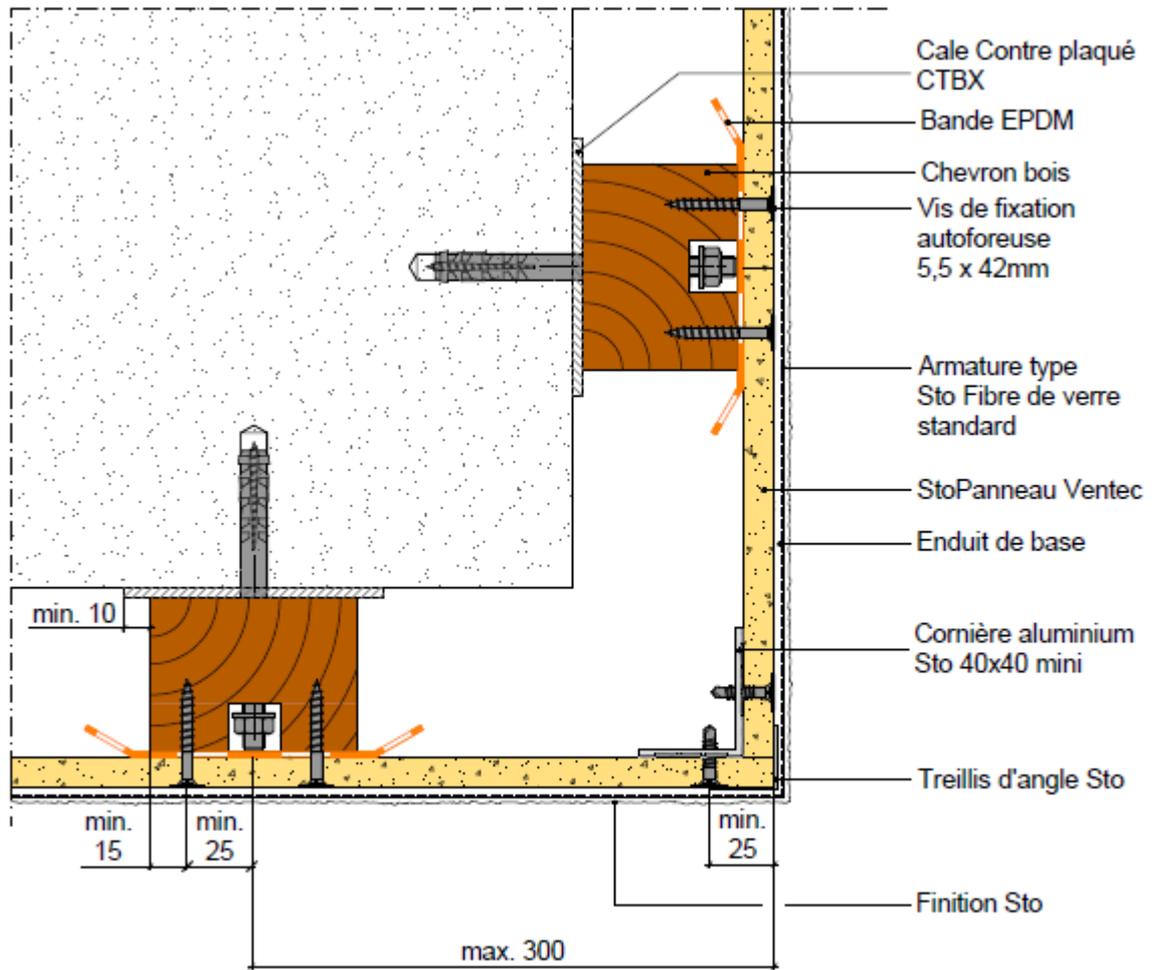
Coupe horizontale - Angle sortant - Pose directe sur support béton
